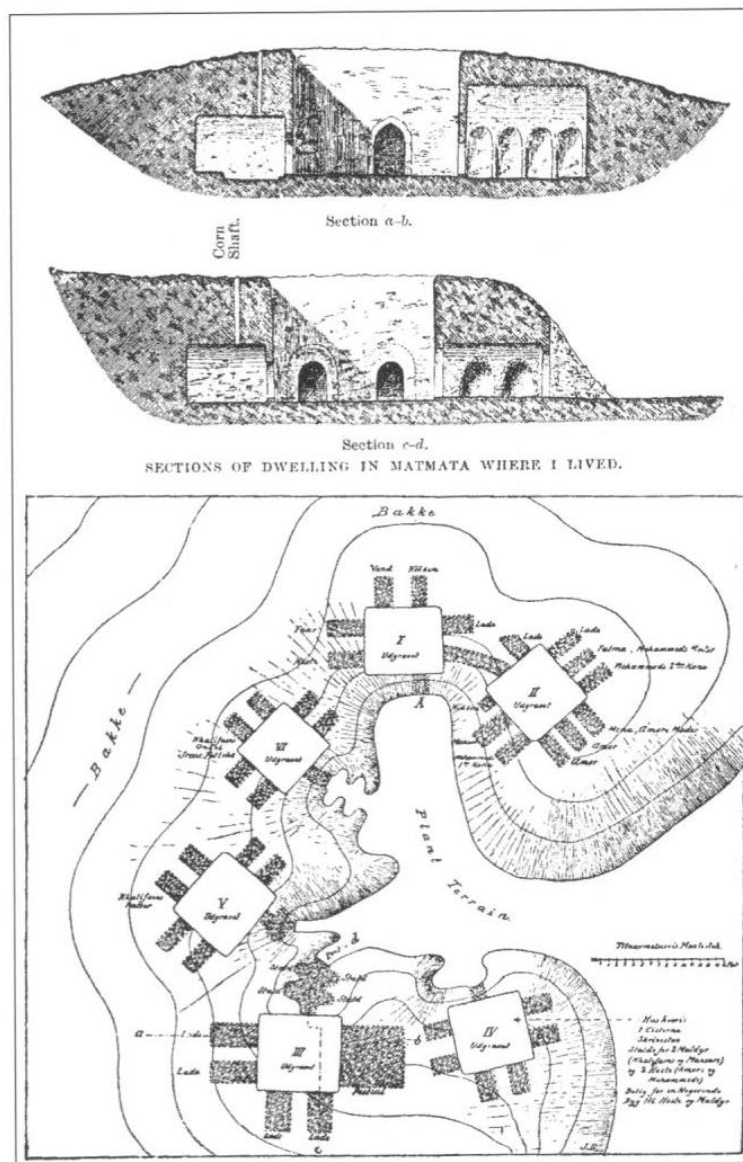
Sezione e pianta dell’abitazione del califfo. Da Bruuns 1898.
